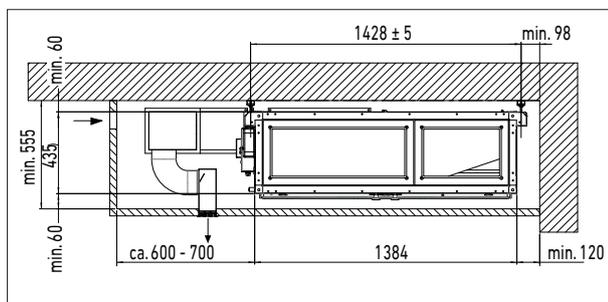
Schnitt durch Deckenkoffer mit angeschlossenem Zuluftdurchlässen
